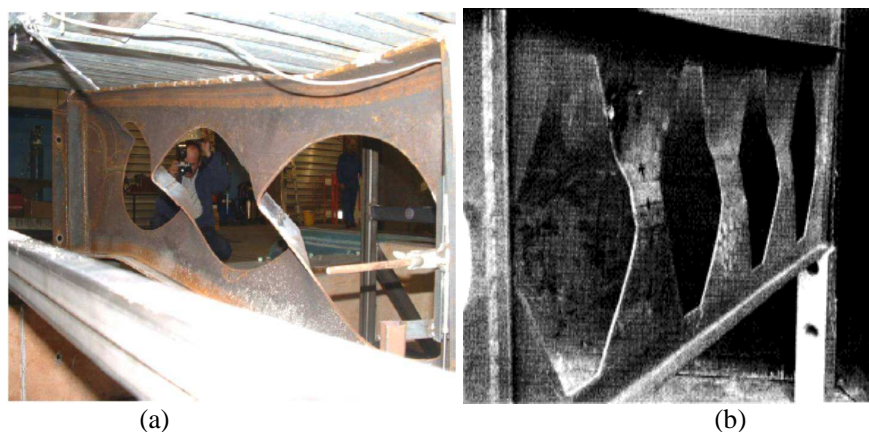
Flambagem do montante de alma em vigas alveolares (a) viga celular (NADJAI *et al.*, 2008); (b) viga castelada (ZAAROUR E REDWOOD, 1996).
